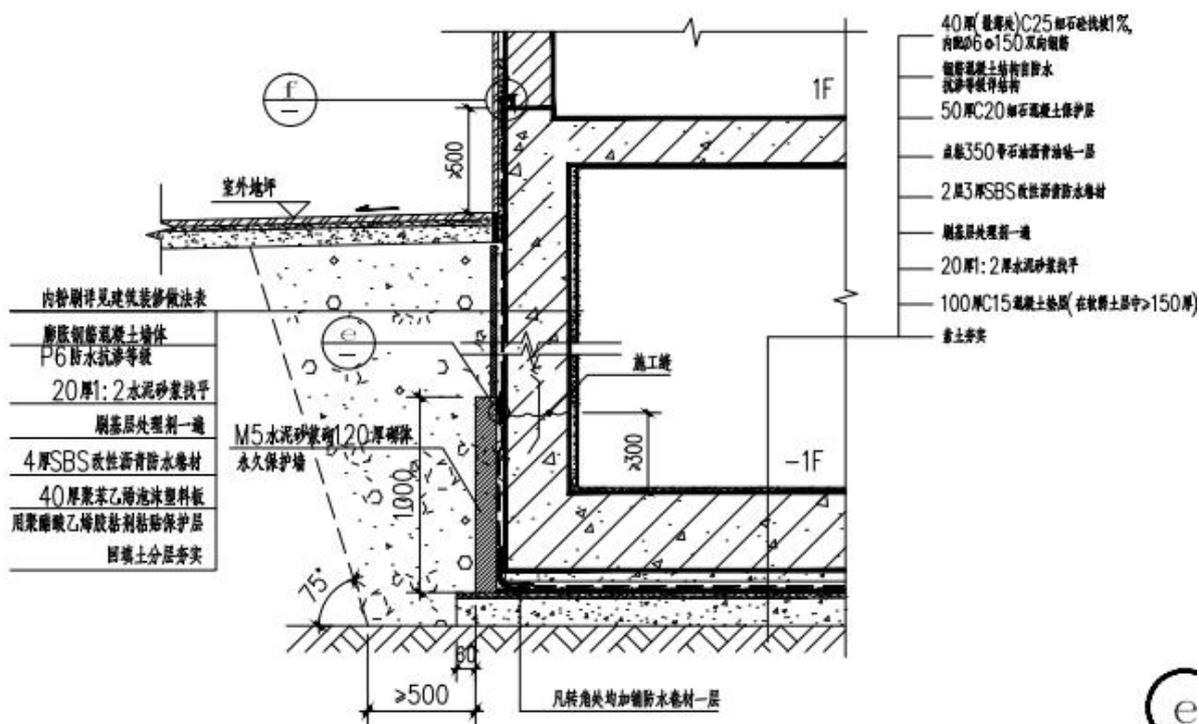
地下工程底板及外壁防水具体施工示意图
